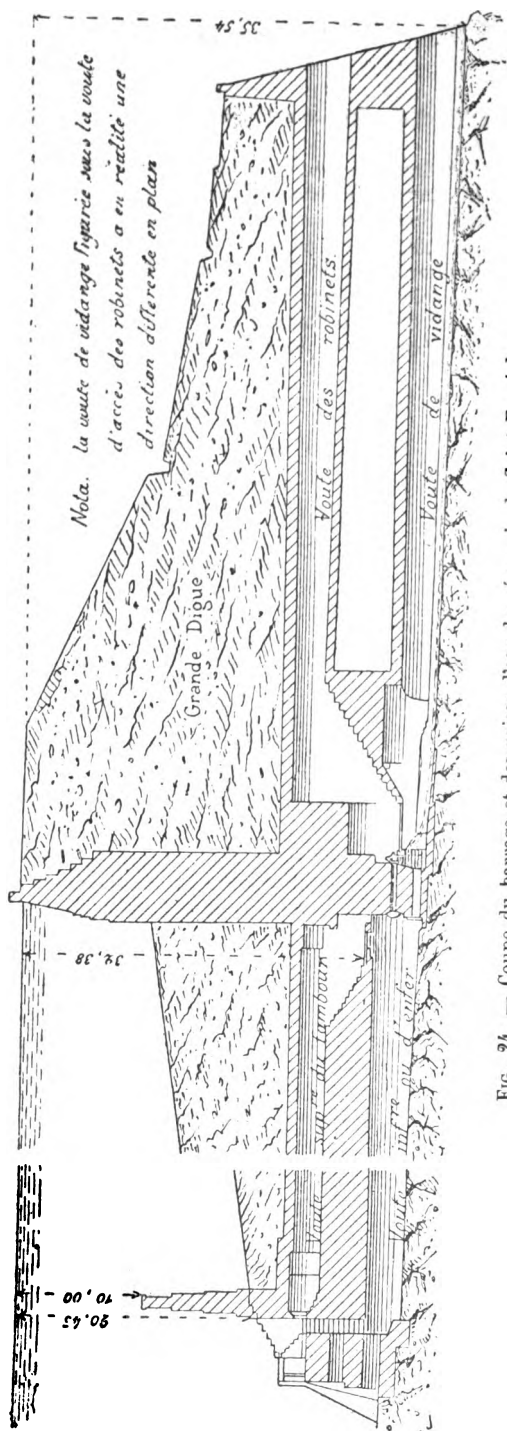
Coupe du barrage et des prises d'eau du réservoir de Saint-Ferréol.
